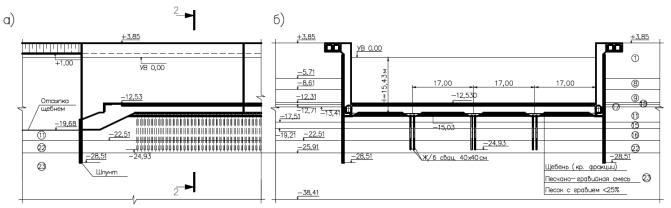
Конструкция головной секции дока: а – продольный разрез; б – поперечный разрез 2-2
